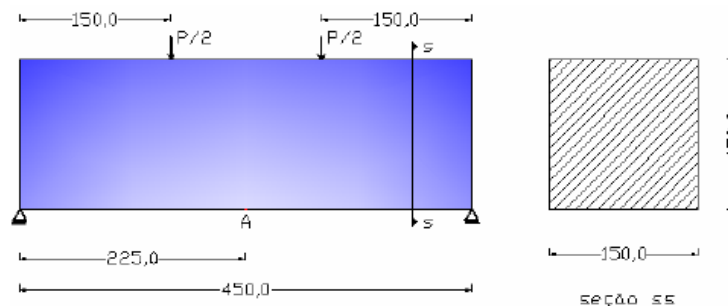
Geometria (mm) e esquema de carregamento das vigas de Agopyan e Nunes (1998) (GROSSI, 2006) (Repetida)
